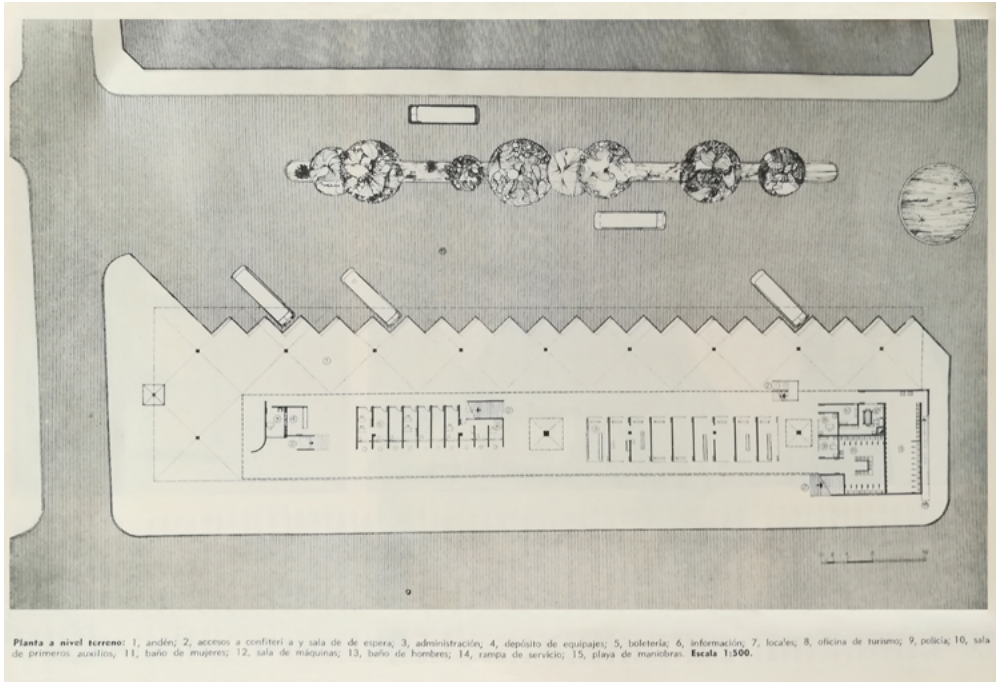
Planta baja. Concurso Estación de Ómnibus de Luján. Fuente: Archivo Juan M. Llauro.
